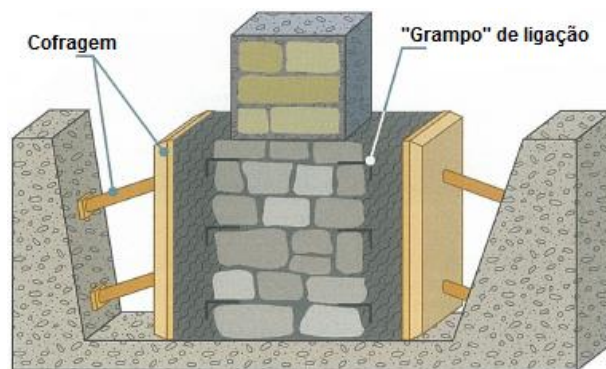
Esquema do reforço de fundação por alargamento da sua base [2]
